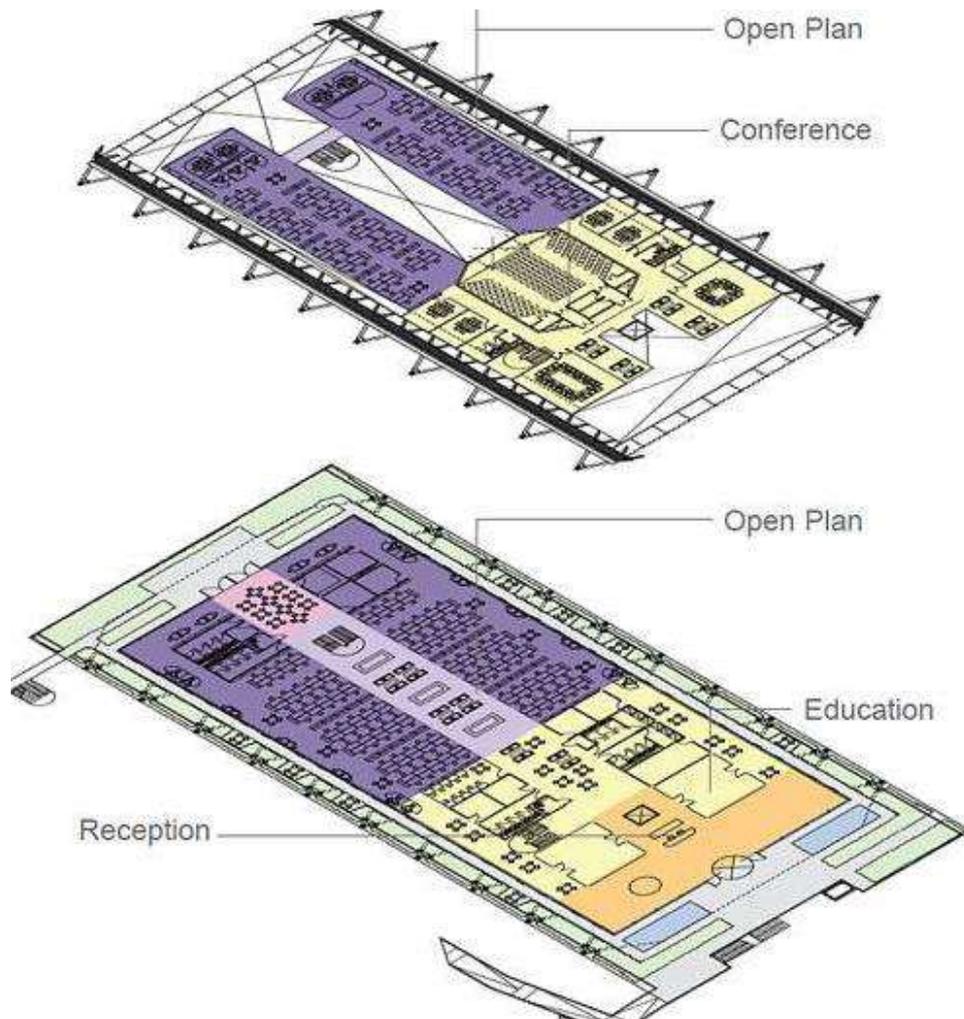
Planta esquemáticas dos dois pavimentos. Fonte: Hopkins Architects.
